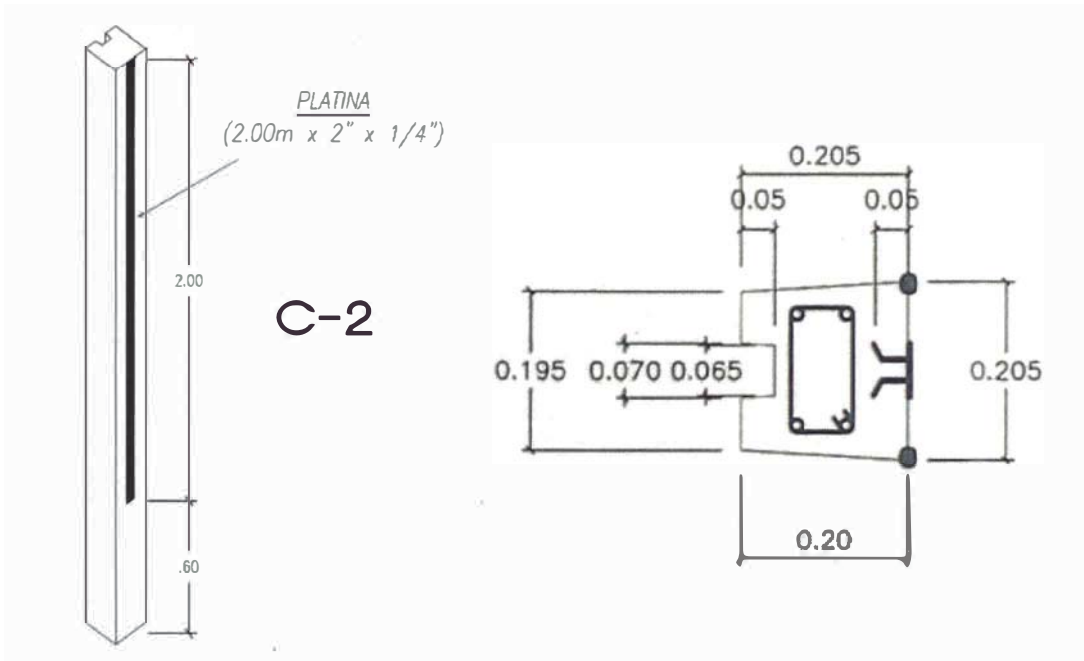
Dimensiones de Columna de concreto armado C2
